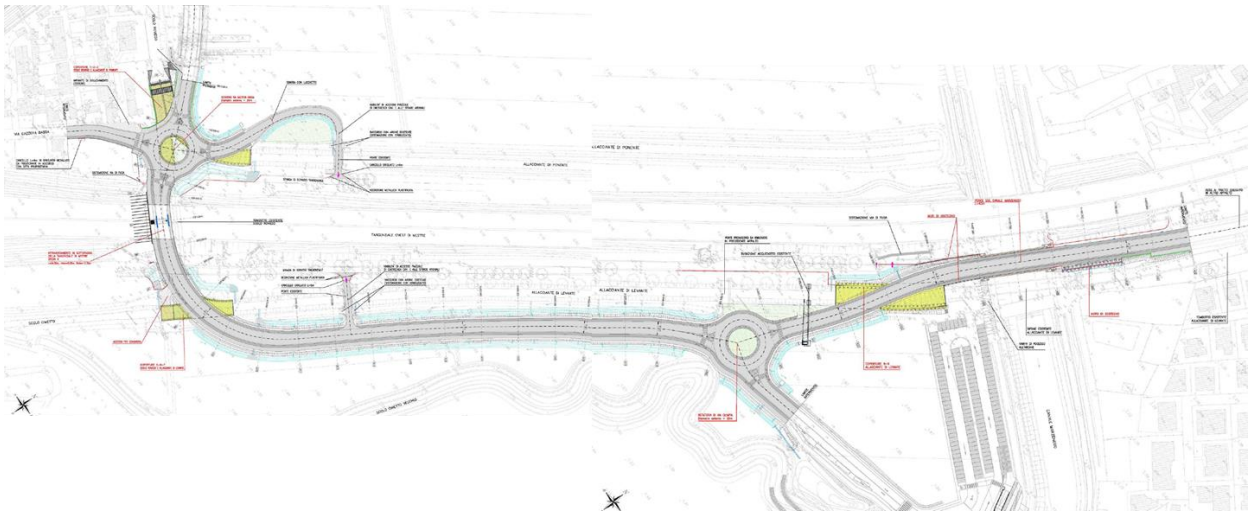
stralcio planimetrico Intervento di Progetto Esecutivo
